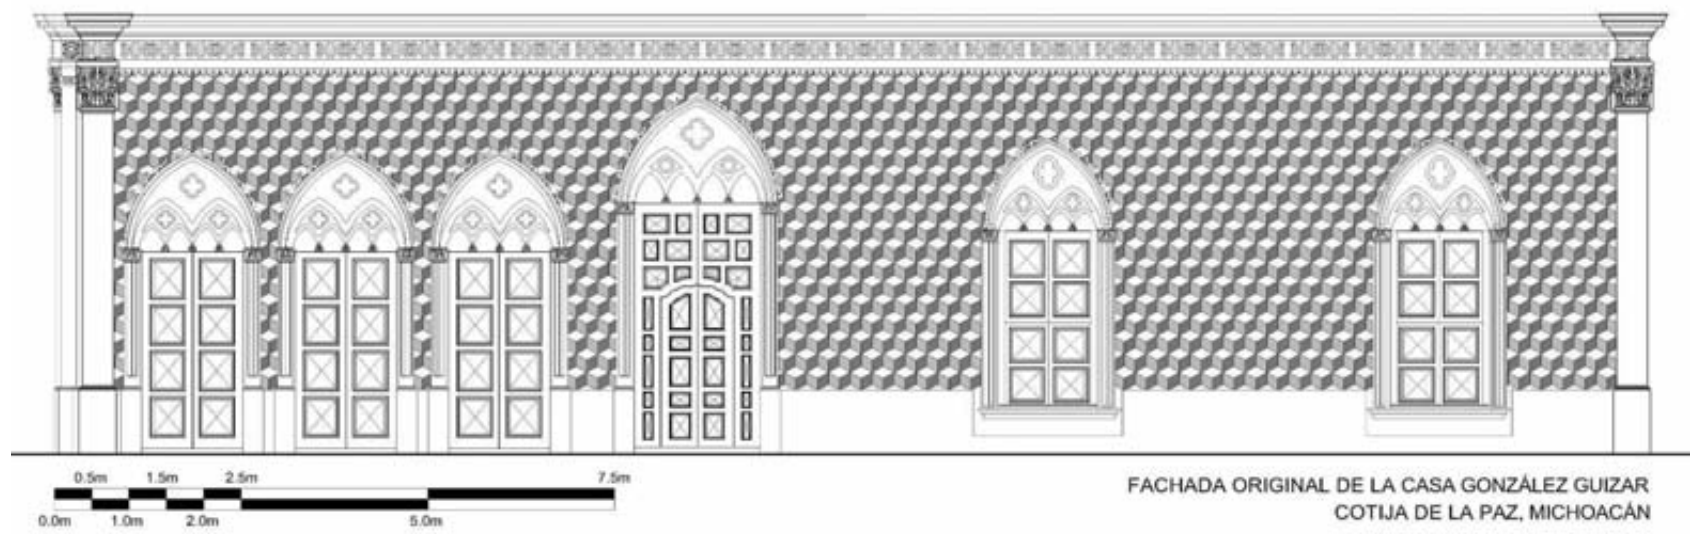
Posible reconstrucción de la fachada con sus muros decorados de la Casa González Guízar
